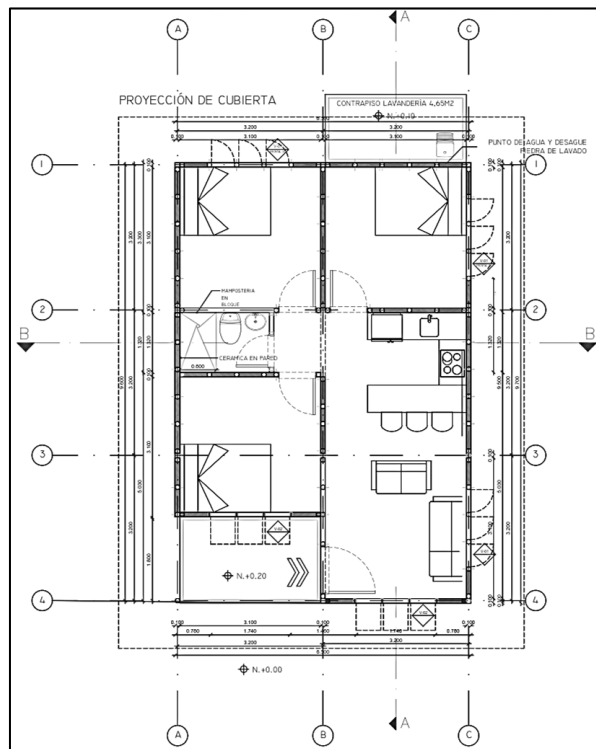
Planta arquitectónica vivienda en caña guadua Fuente: (MIDUVI, 2023)
